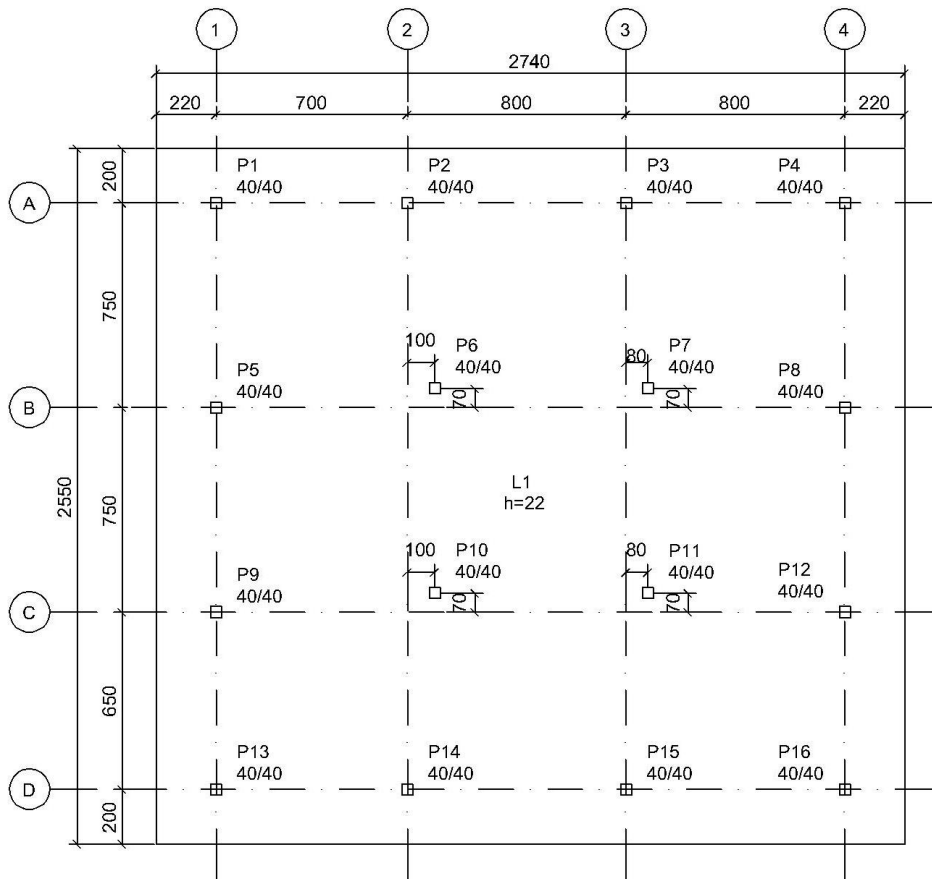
Planta do pavimento, medidas em cm (BARBOSA, 2014).
